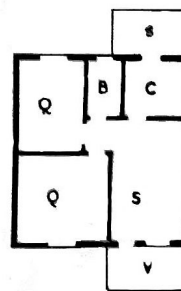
Plantas da unidade A2 e F3. Fonte: arquivo INSS.
